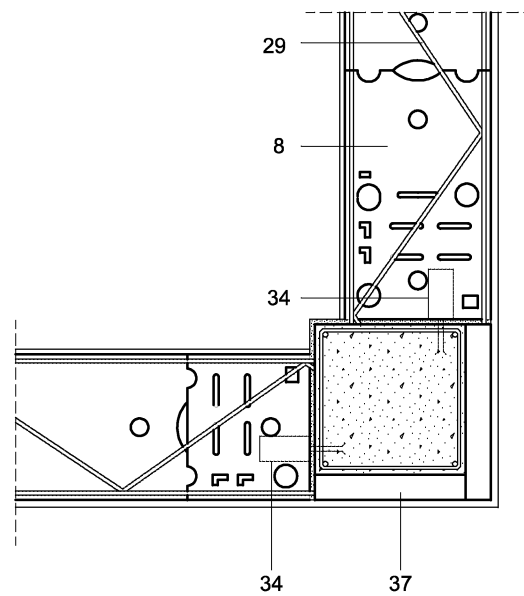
Encuentro con pilar en esquina hilada impar. Muro portante. Bloque de longitud 50.
